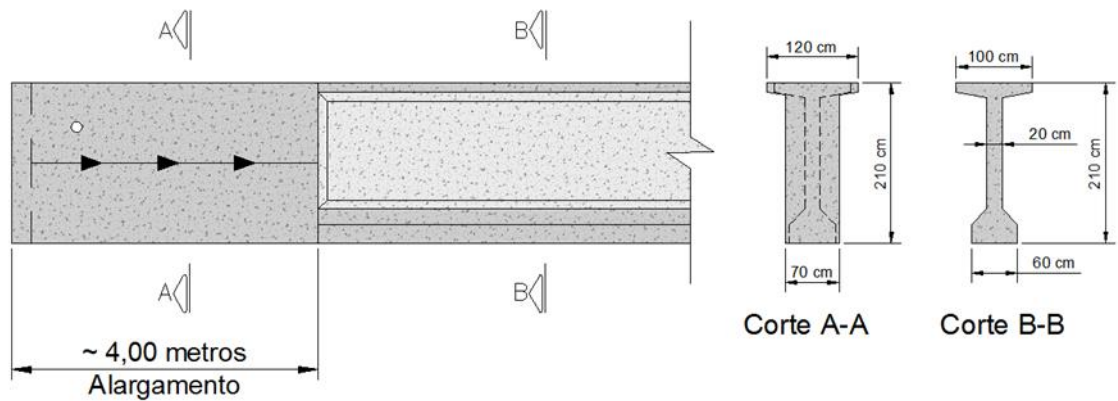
Vista longitudinal de viga mostrando o trecho de engrossamento da alma e seções transversais.
